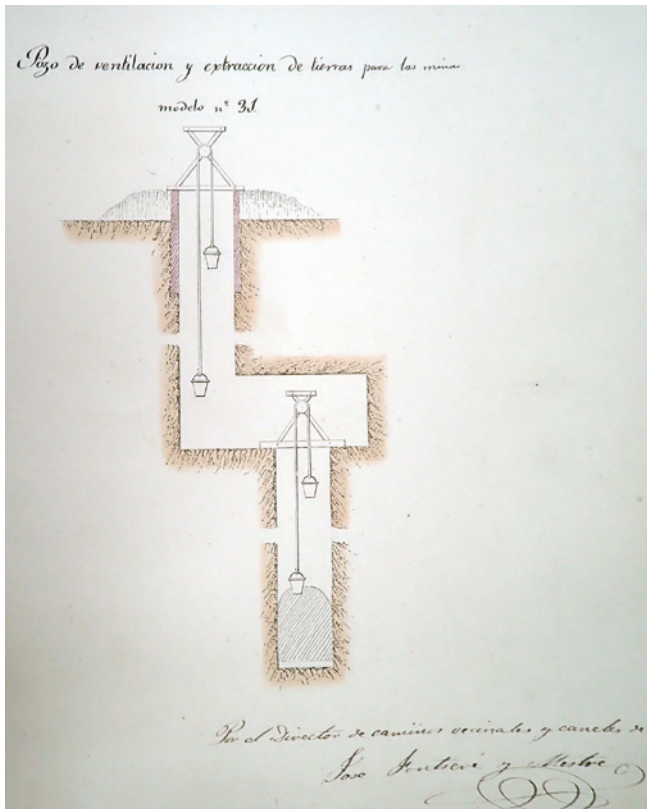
Detalle de pozo para excavación y ventilación con la firma del autor.
